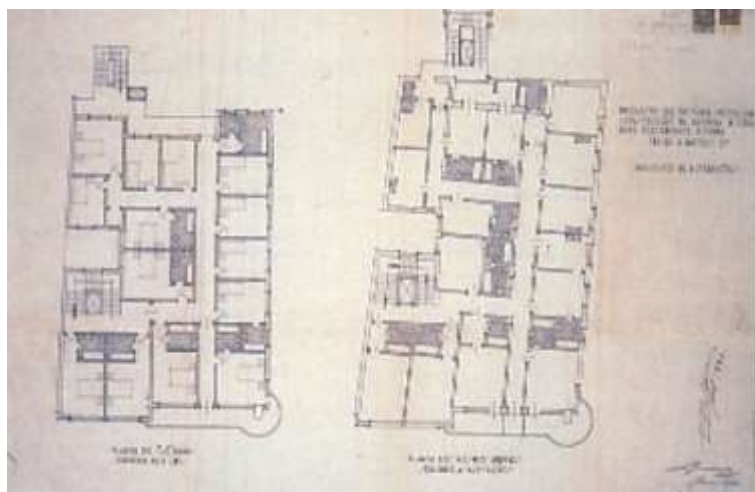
Plantas e espaço interior do Hotel Vitória (Landrove, 2011, p. 303)
